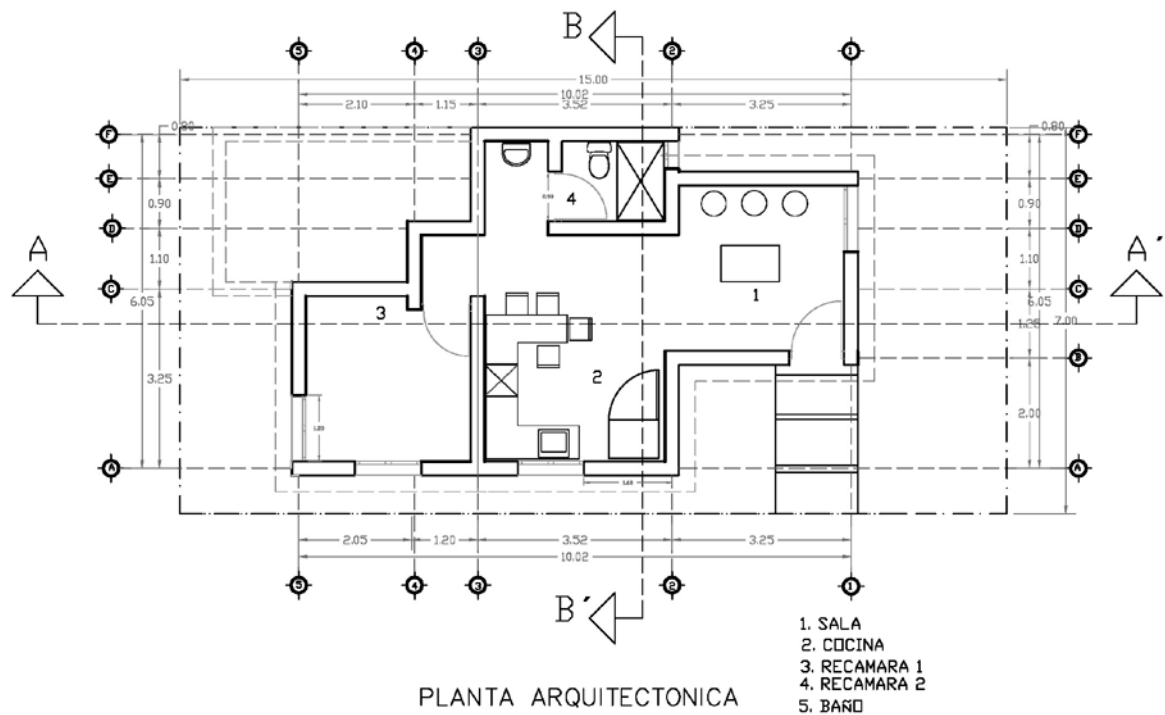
Plano de planta arquitectónica de vivienda experimental sustentable
